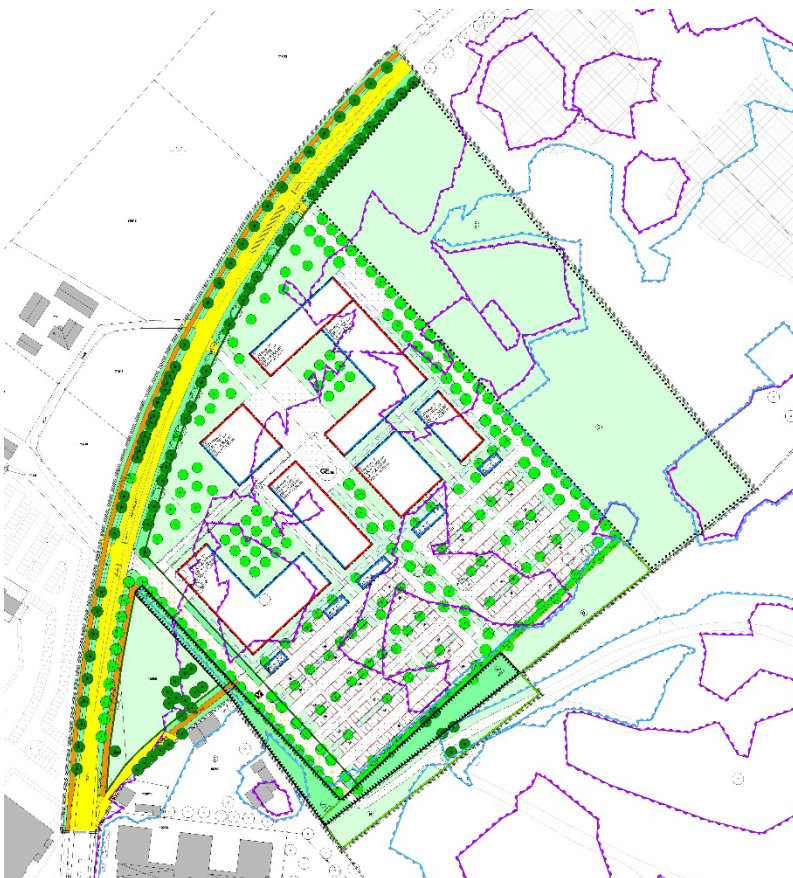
Bebauungsplan „Ochsenau - Bereich West“
